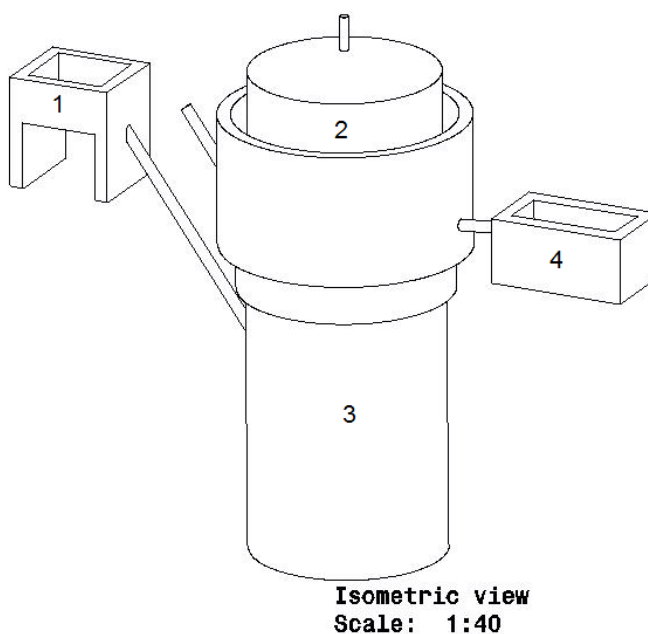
Vista isométrica do biodigestor dimensionado pela CESP.
